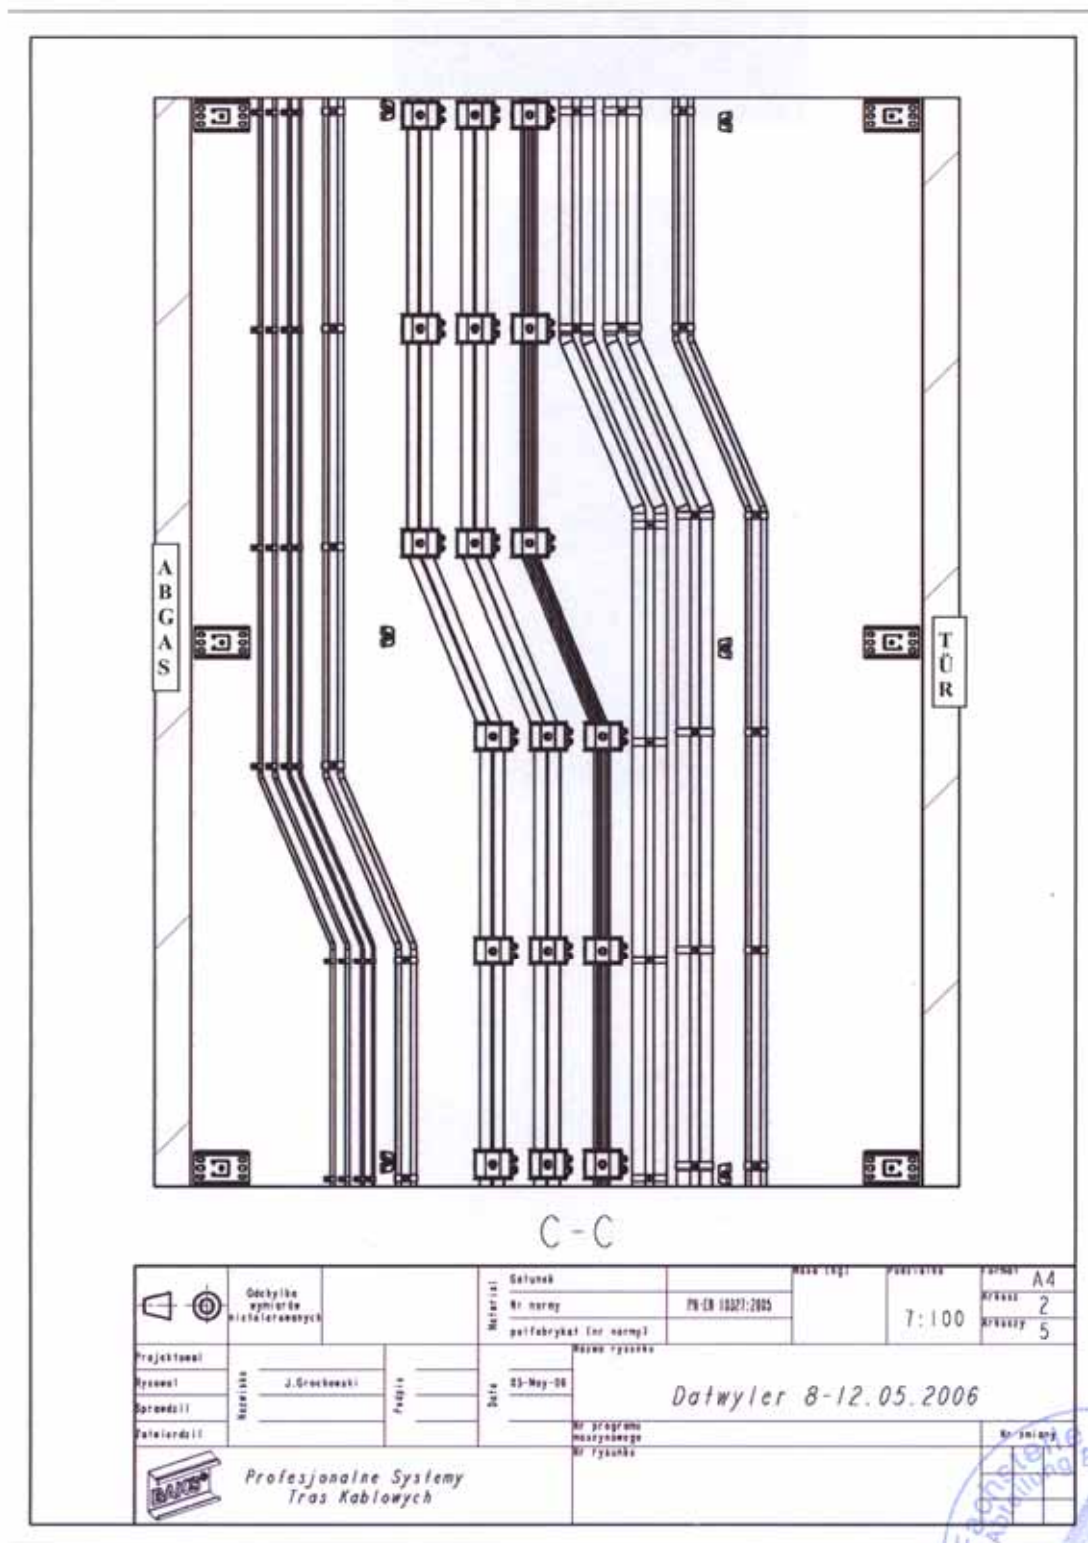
Grundriss der montierten Tragsysteme
